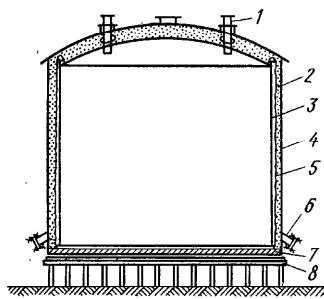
Изотермический двухстенчатый резервуар типа «резервуар в резервуаре»:
